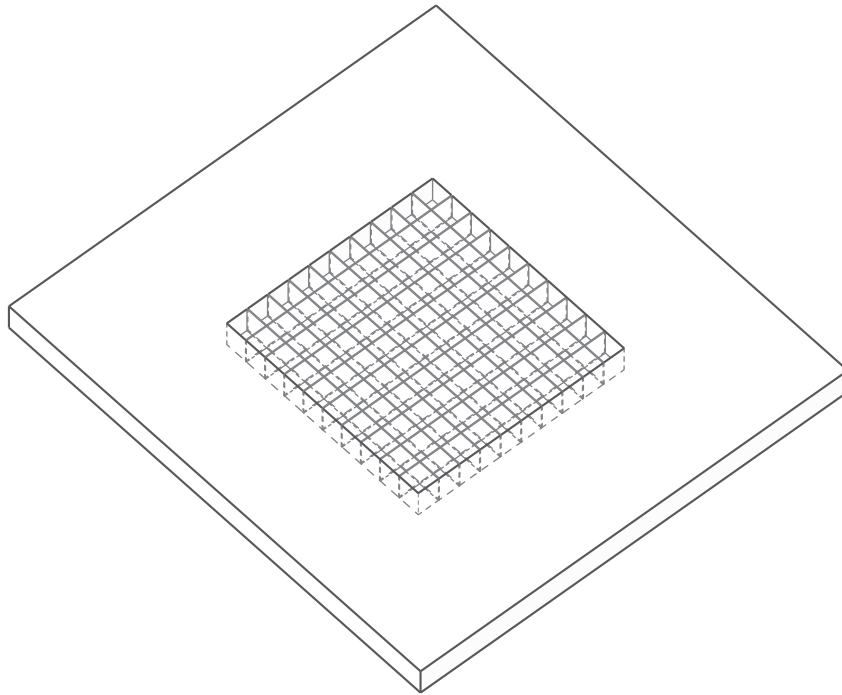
Axonometrie und Grundrisse Werkstätten
